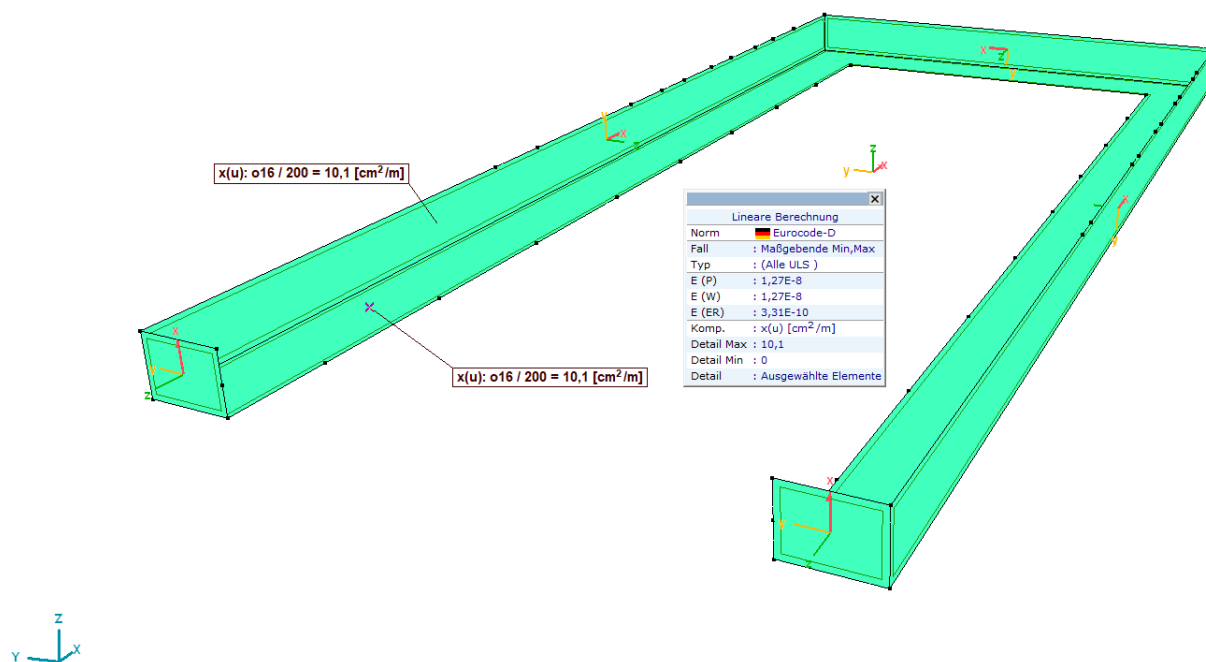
Entworfenere Bewehrung außen/unten in lokaler x-Richtung
